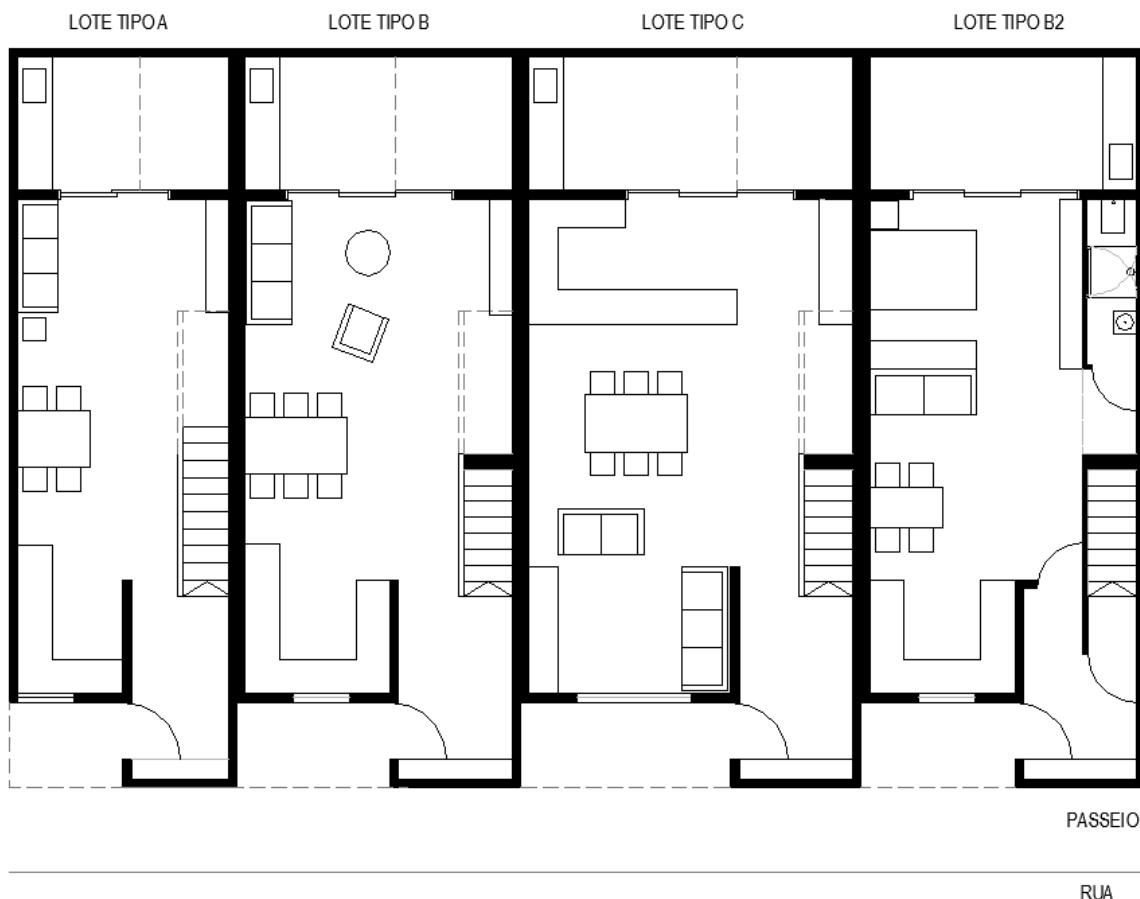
Plantas do piso térreo dos três tipos de lotes. Fonte: Autor
